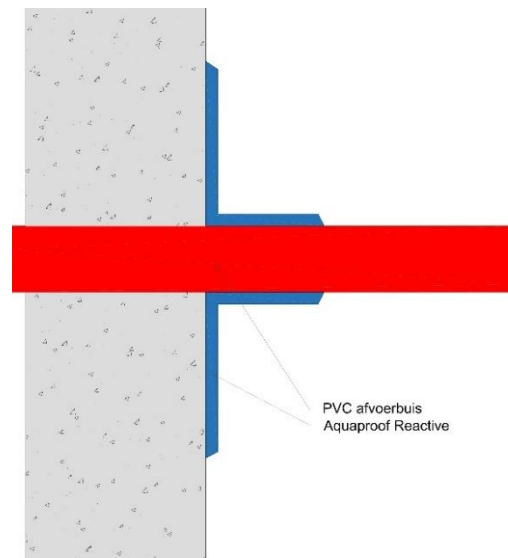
Waterdichting ter hoogte van doorvoeren: ingestorte buis
